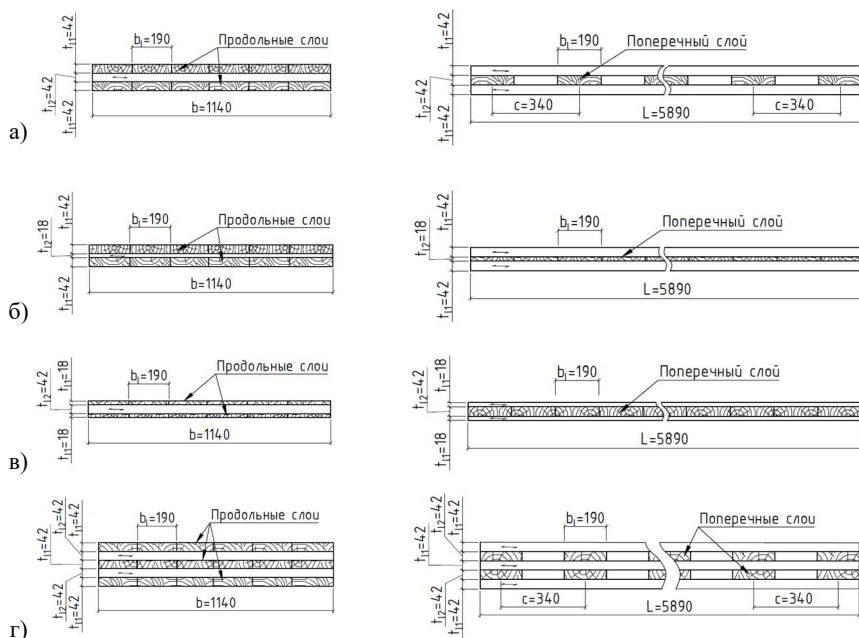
, начало – Сечения (поперечное и продольное) исследуемых плит перекрытия из ДПК
